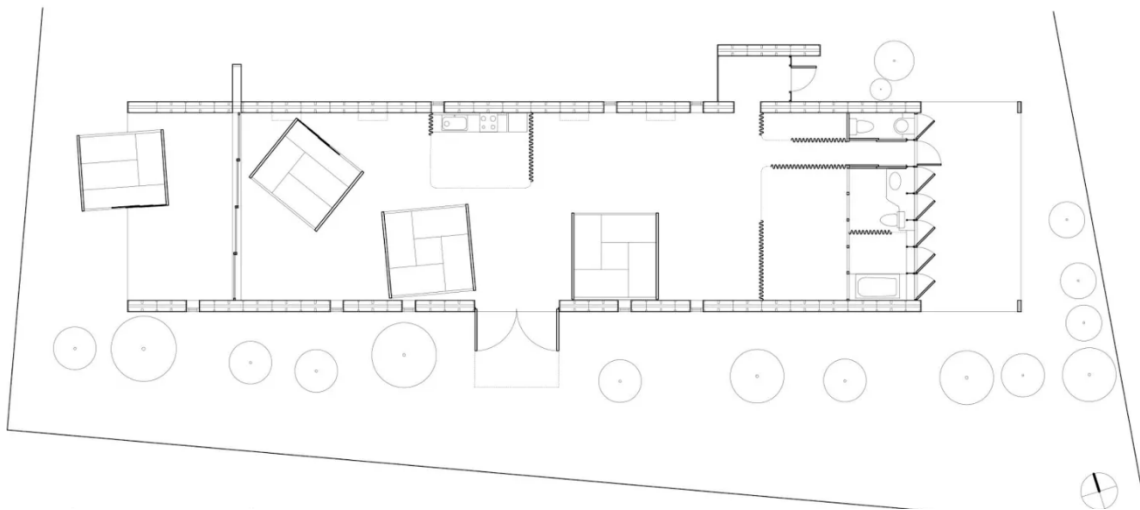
Naked House, Shigeru Ban. Plano de planta.
